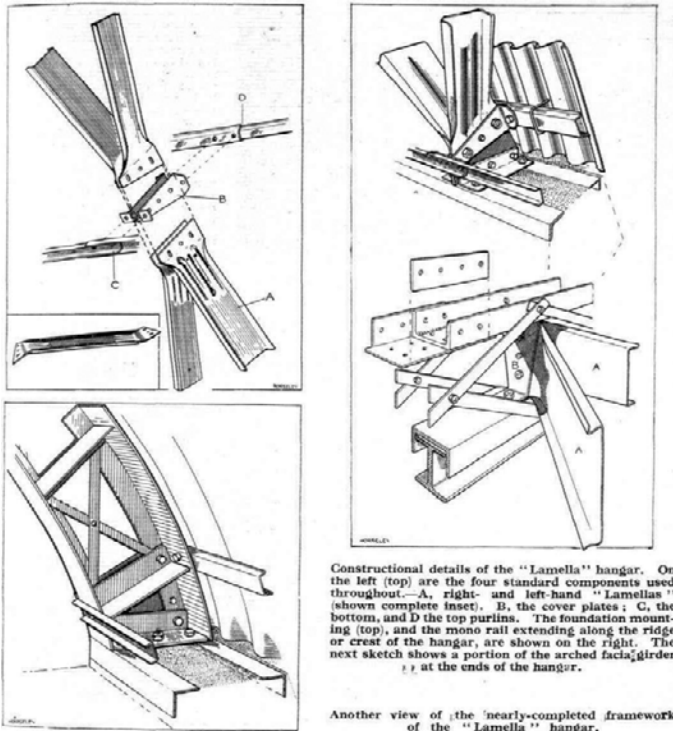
Details und Bauansicht einer Lamellenhalle nach Junkersscher Bauart. Aus: *Flight* (18.07.1930) Seite 805.
